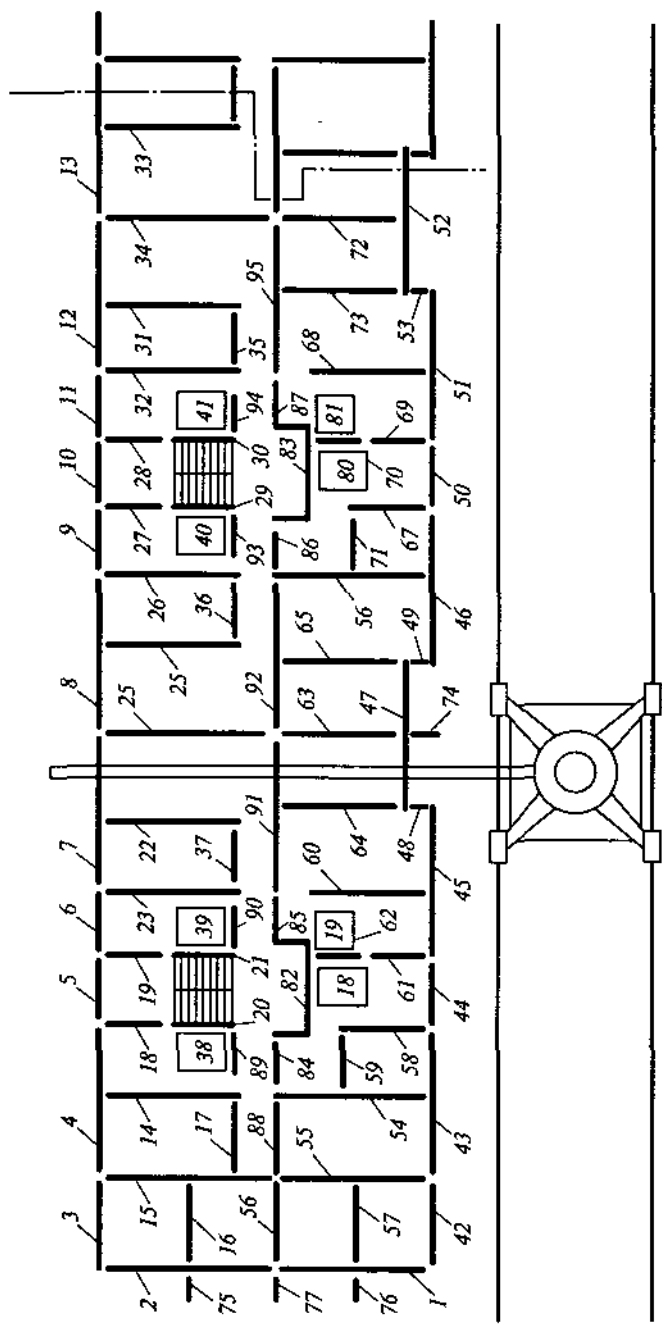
Последовательность монтажа элементов крупнопанельного здания с продольными несущими стенами
